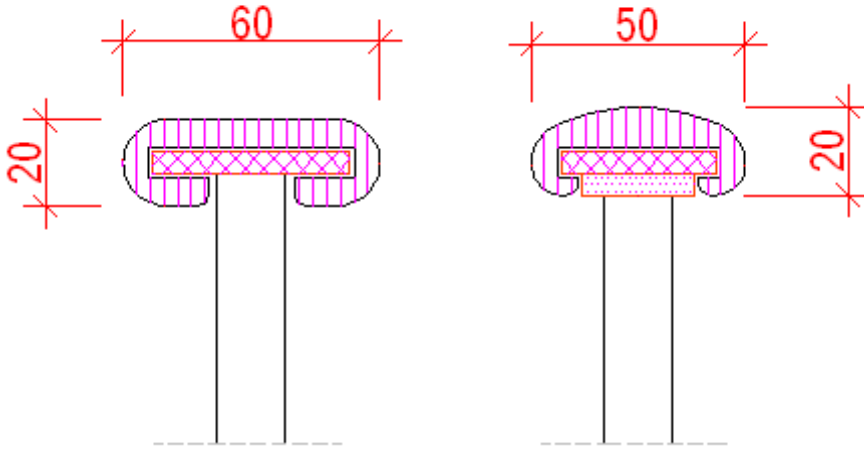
Ahşap profil örnekleri (ölçüler mm)
